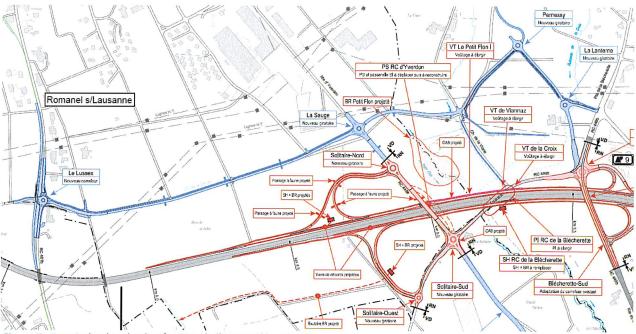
Extrait du plan de planification de l'OFROU (état 2013)
